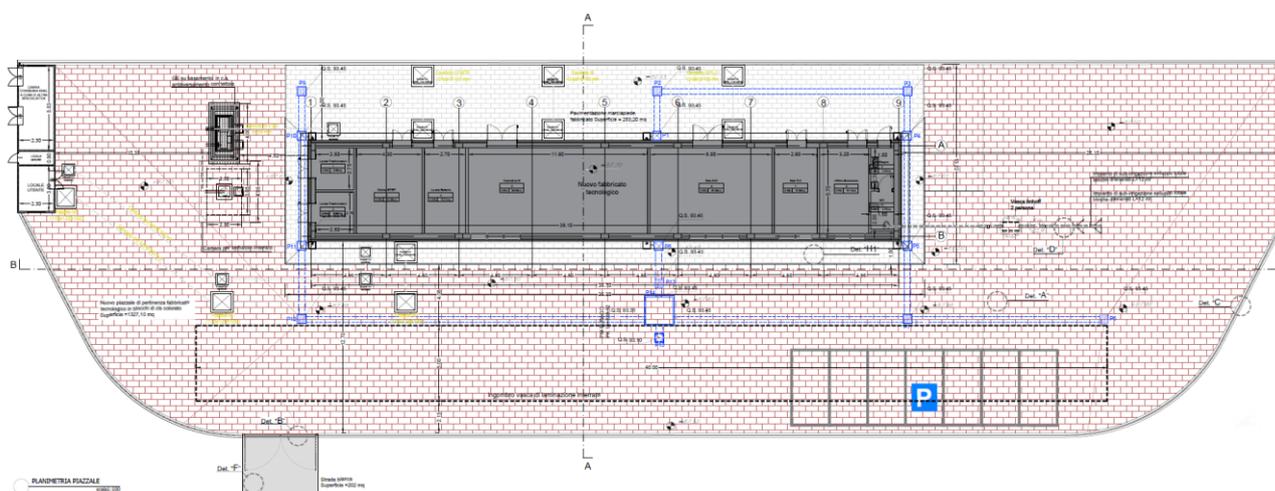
PM Turago - Estratto della planimetria idraulica
